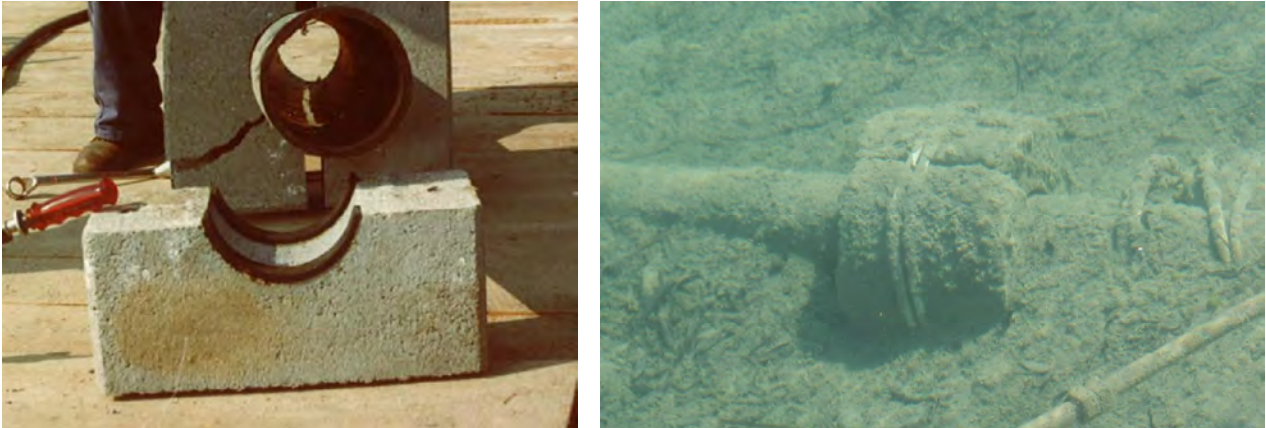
Montage der Beschwerungsgewichte; Links: Gummieinlagen in den Betonhalbschalen und Befestigung mit verzinkten Schrauben (Bildquelle: WV Ossiacher See); Rechts: Metallbänder um runde Betonhalbschalen (Bildquelle: Ortsbegehung Faaker See)
